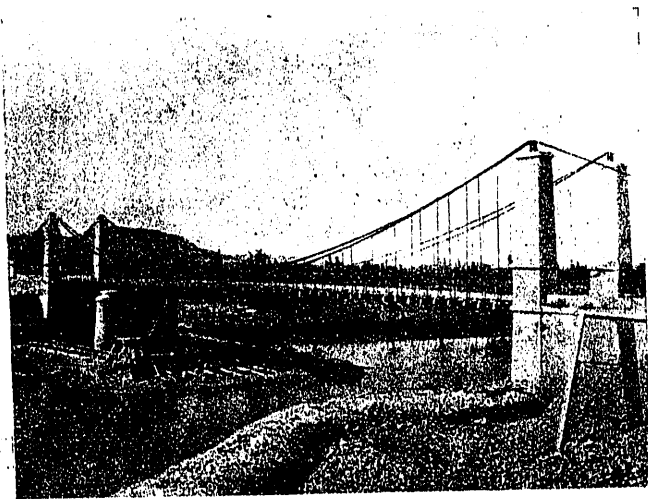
ª Puente colgante y ataguía para la cimentación de la primera pila del nuevo puente.
